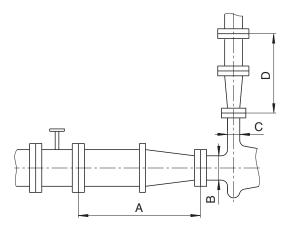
Gerade Rohrleitungslängen vor und nach der Pumpe (empfohlen)
